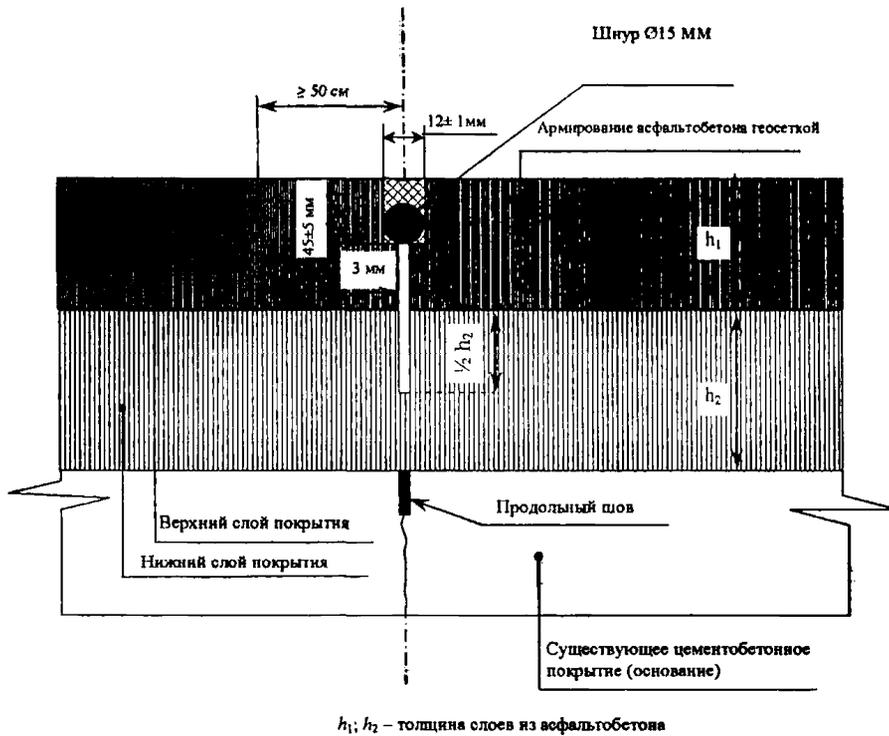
Схема конструкции шва и расположение армирующей прослойки при локальном армировании продольного шва (поперечное сечение)
